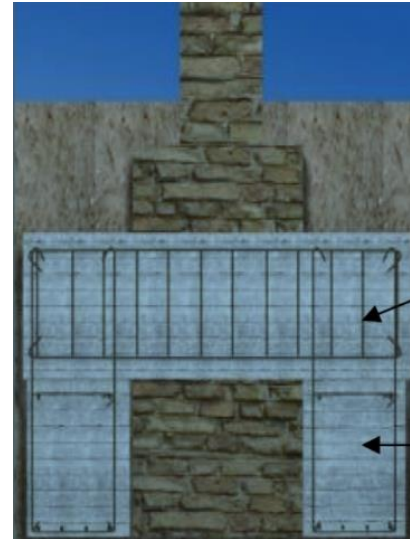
renforcement des fondations par des poutres longitudinales rattachées par des poutres transversales
